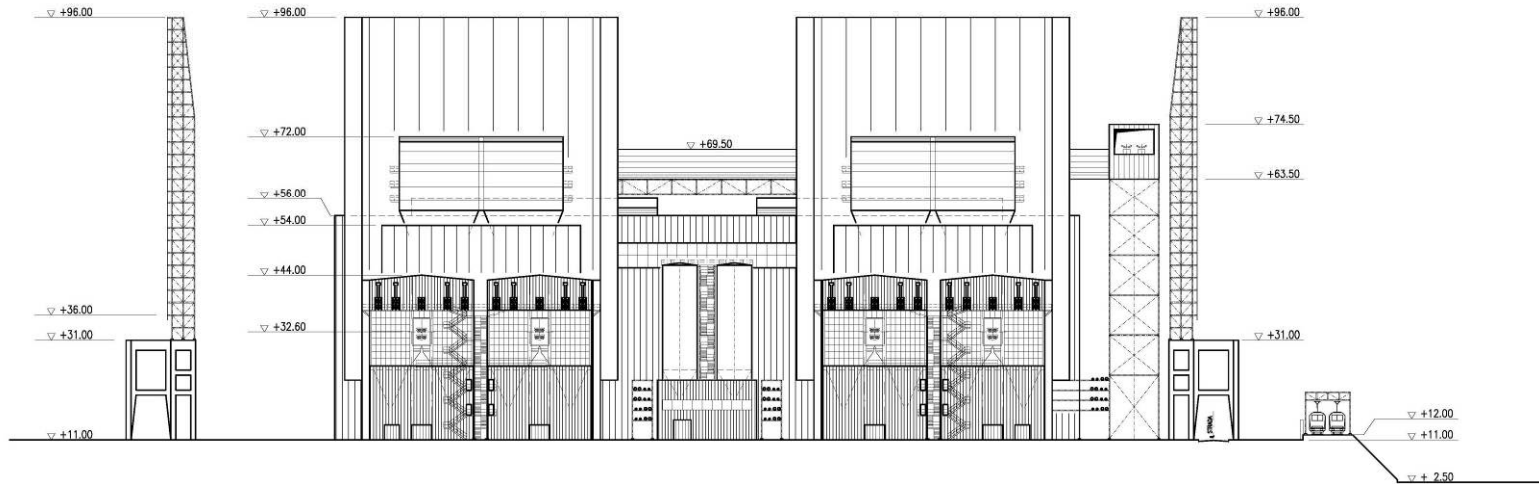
Saline Joniche – Sezione dell’impianto – caldaie (Estratto dalla Tavola di Progetto n. BD0362A-0-01-002)
